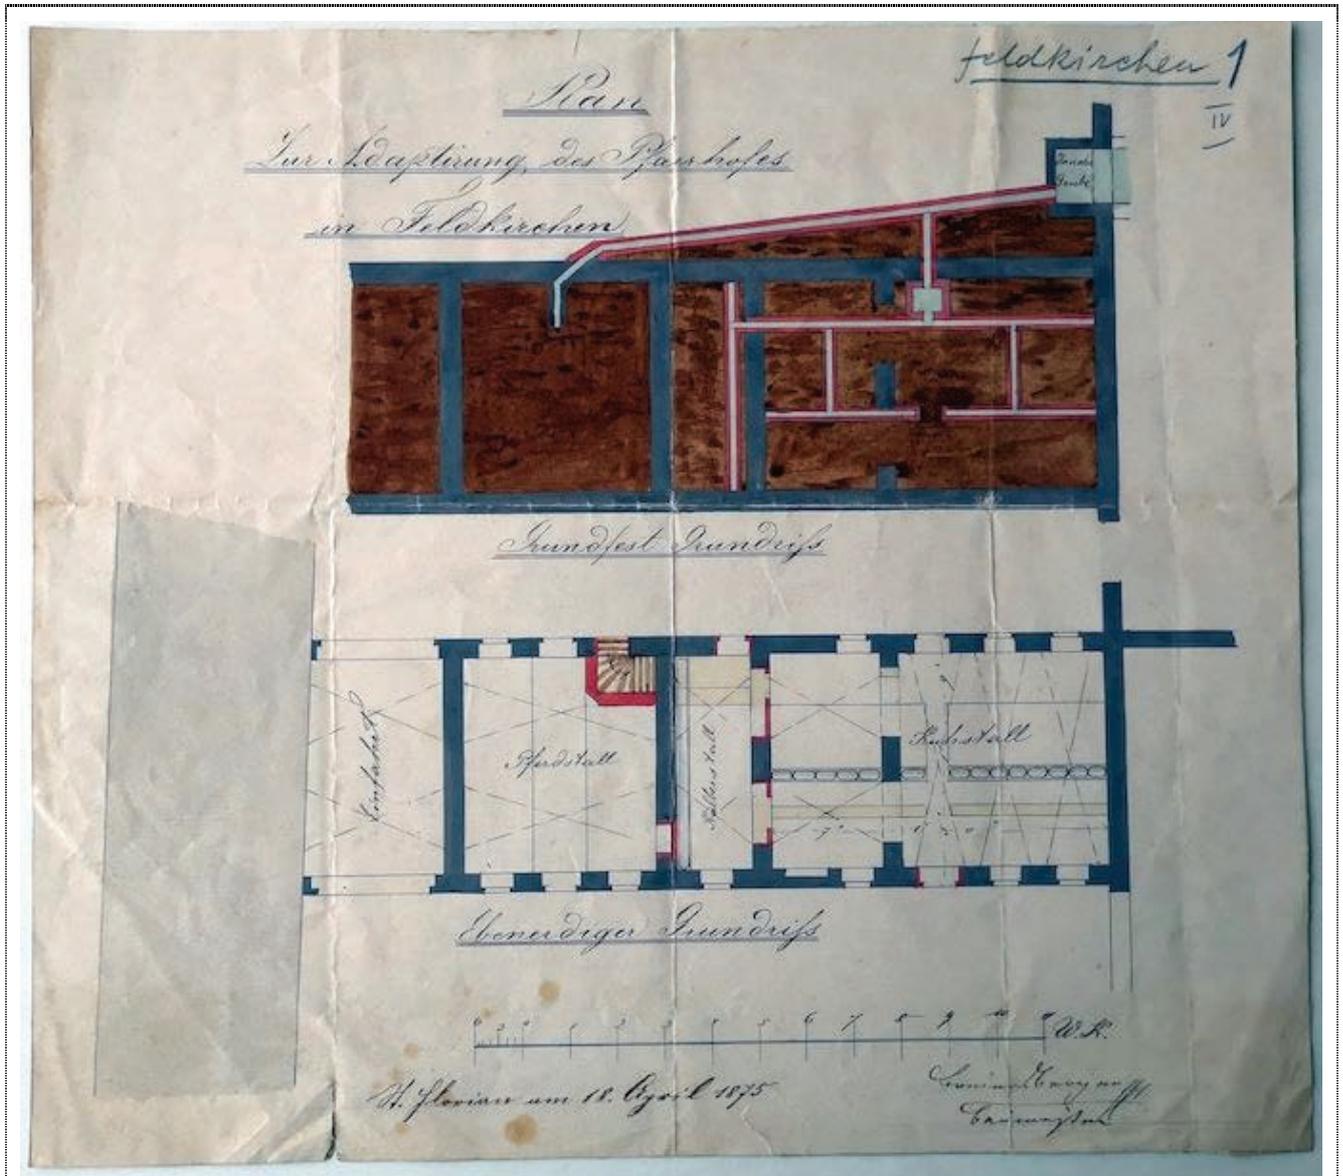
Grundriss des Hofflügels, Erdgeschoß mit Pferdestall, Kälberstall und Kuhstall; Einbau der Stiege in das 1.Obergeschoß und Errichtung einer Senkgrube, datier 1875; Stiftsarchiv St. Florian, Planmappe
